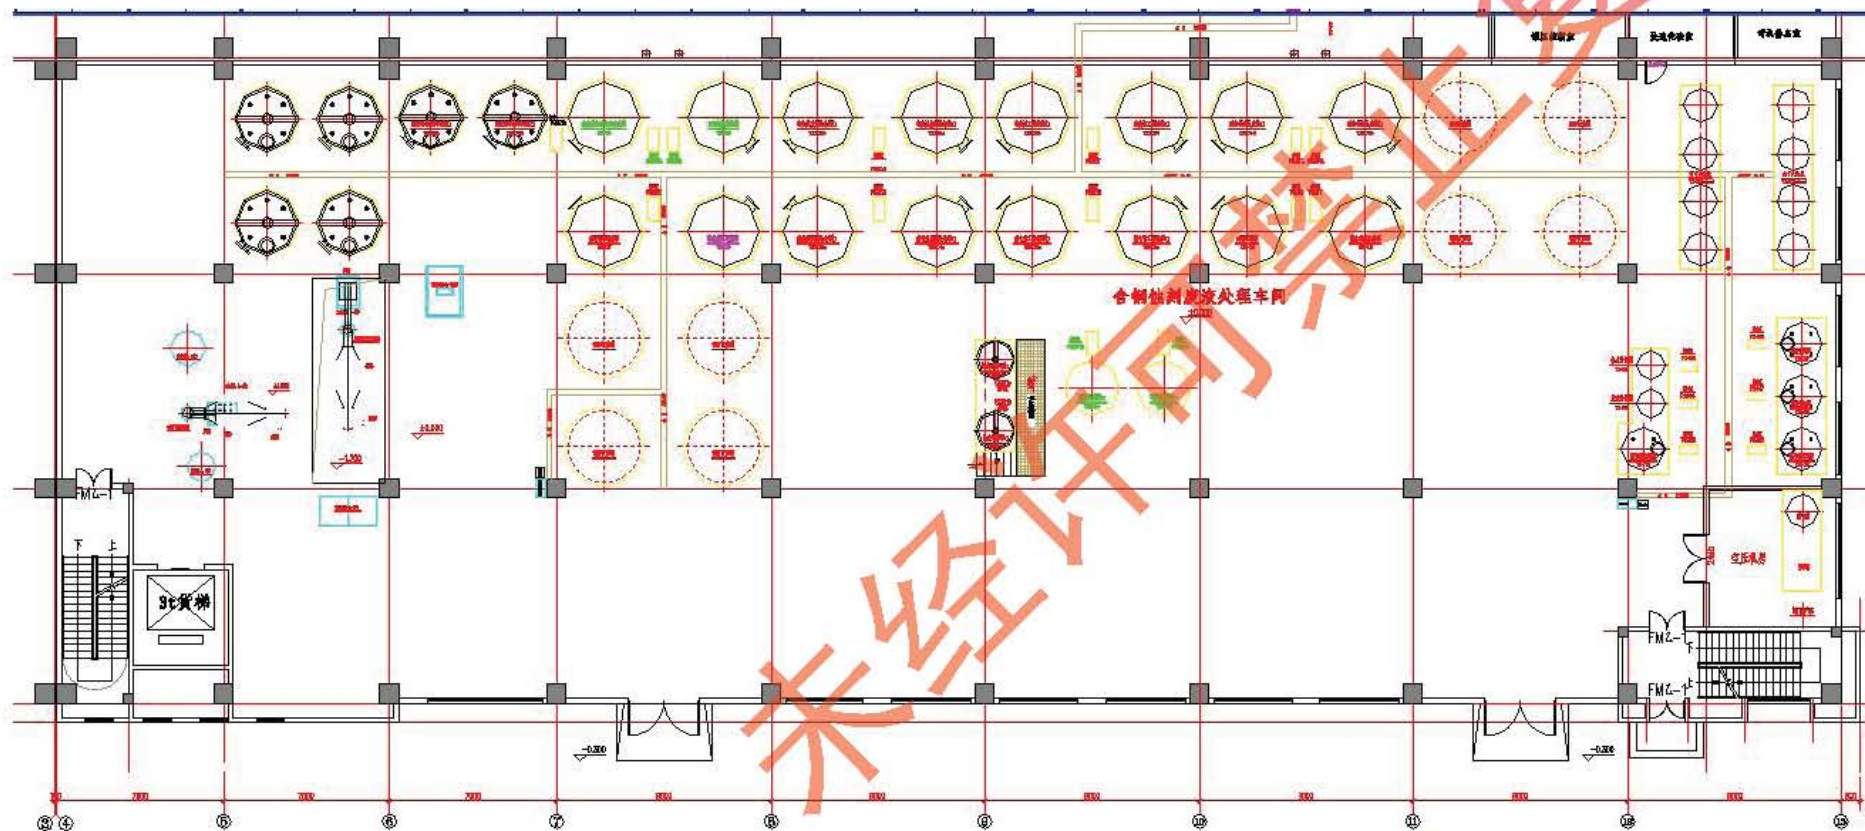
含铜蚀刻废液车间一层平面图
